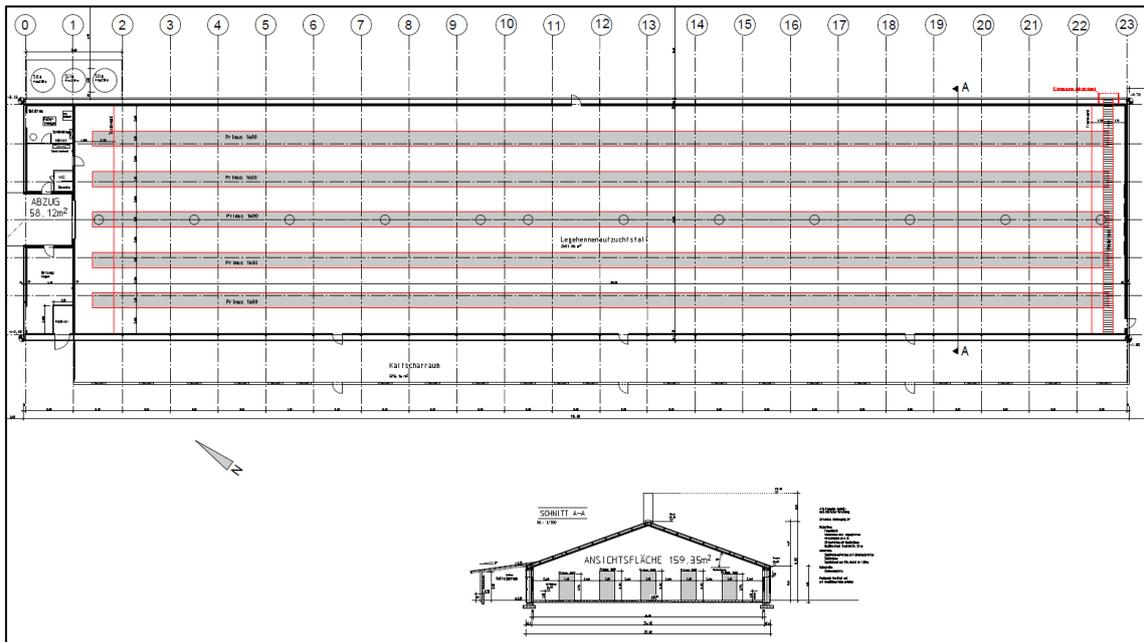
Eingabeplan des geplanten Junghennenaufzuchtstalles (Ingenieurbüro Rausch und Partner)
